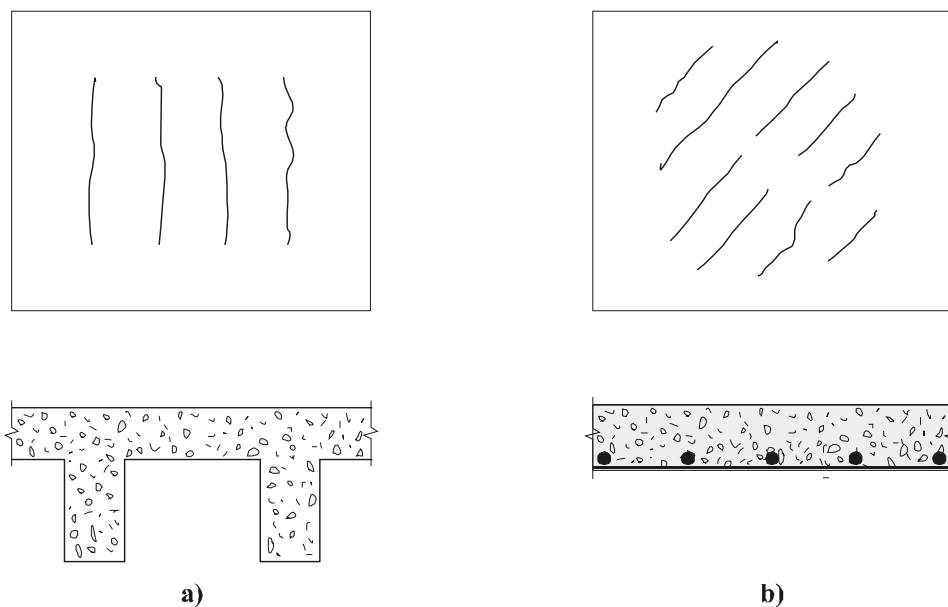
Fissuras provocadas pelo ressecamento do concreto; a) lajes nervuradas
